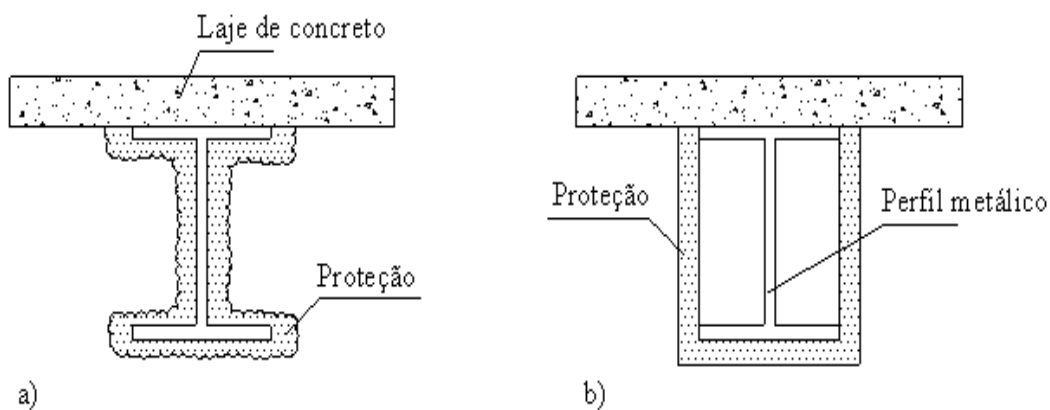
(a) Proteção tipo contorno e (b) Proteção tipo caixa, aplicados à uma viga I sobreposta por laje de concreto.
